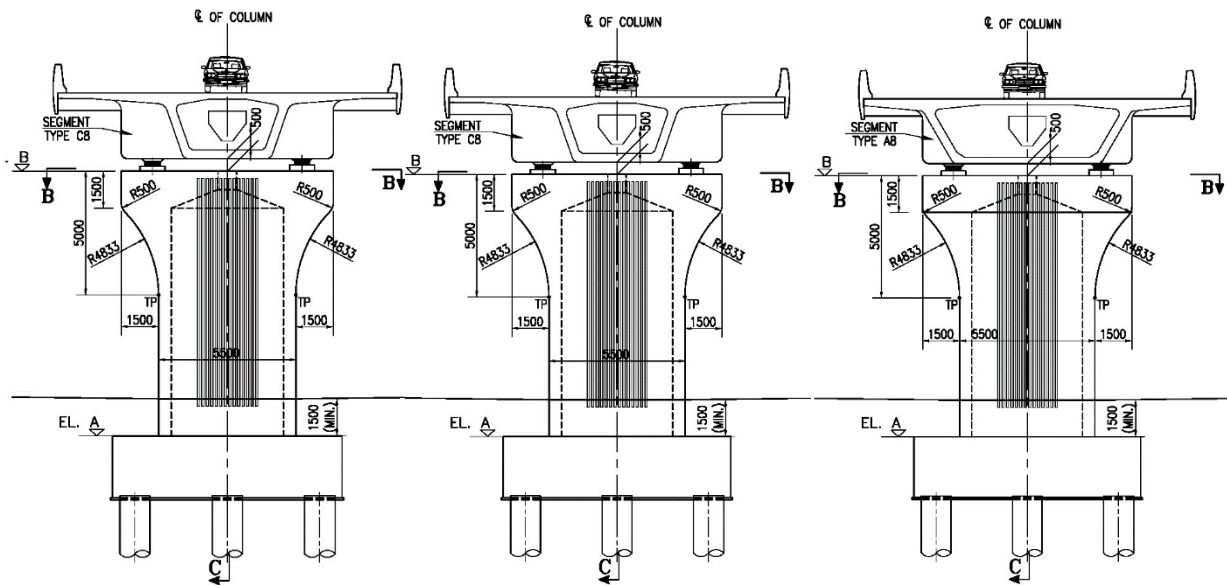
Pilas y diafragmas rediseñados en rampa NRA.
